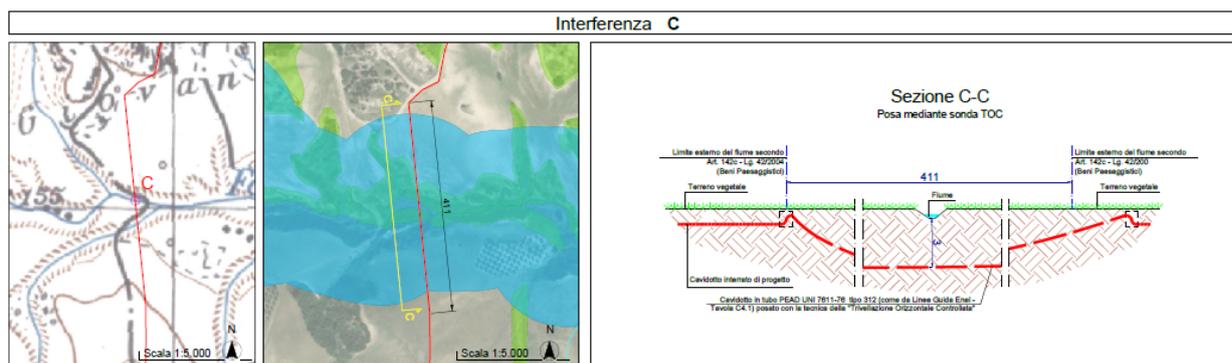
Stralcio studio degli attraversamenti – “CRC-CIV-TAV-017 – Studio degli attraversamenti”
